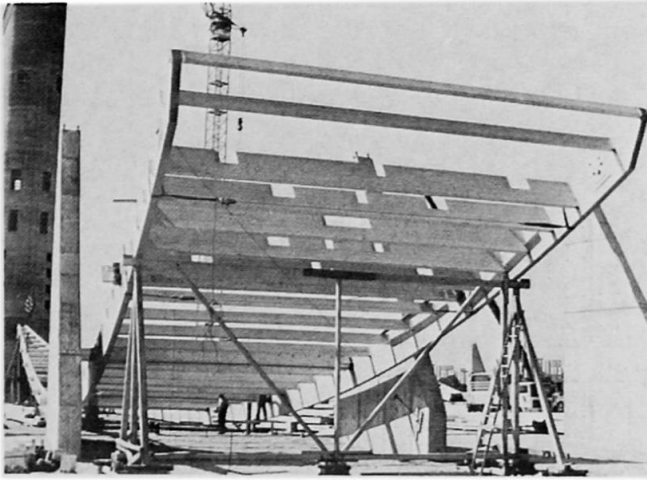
Die fertigmontierten Dachsegmente, einschliesslich der Sparren und der vernagelten Bohlenlage, werden durch 3 Kräne eingehoben
